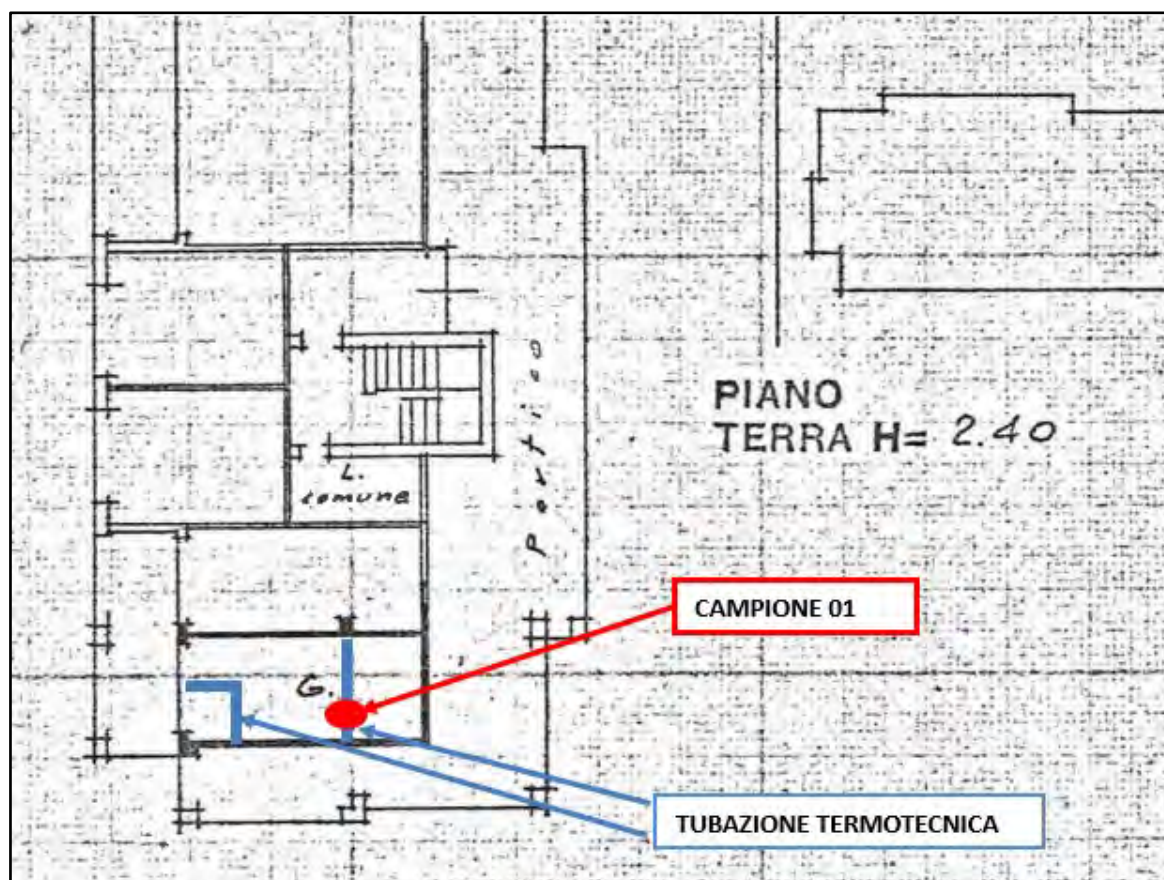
Pianta piano terra garage, con indicazione punto di prelievo campione n. 01
